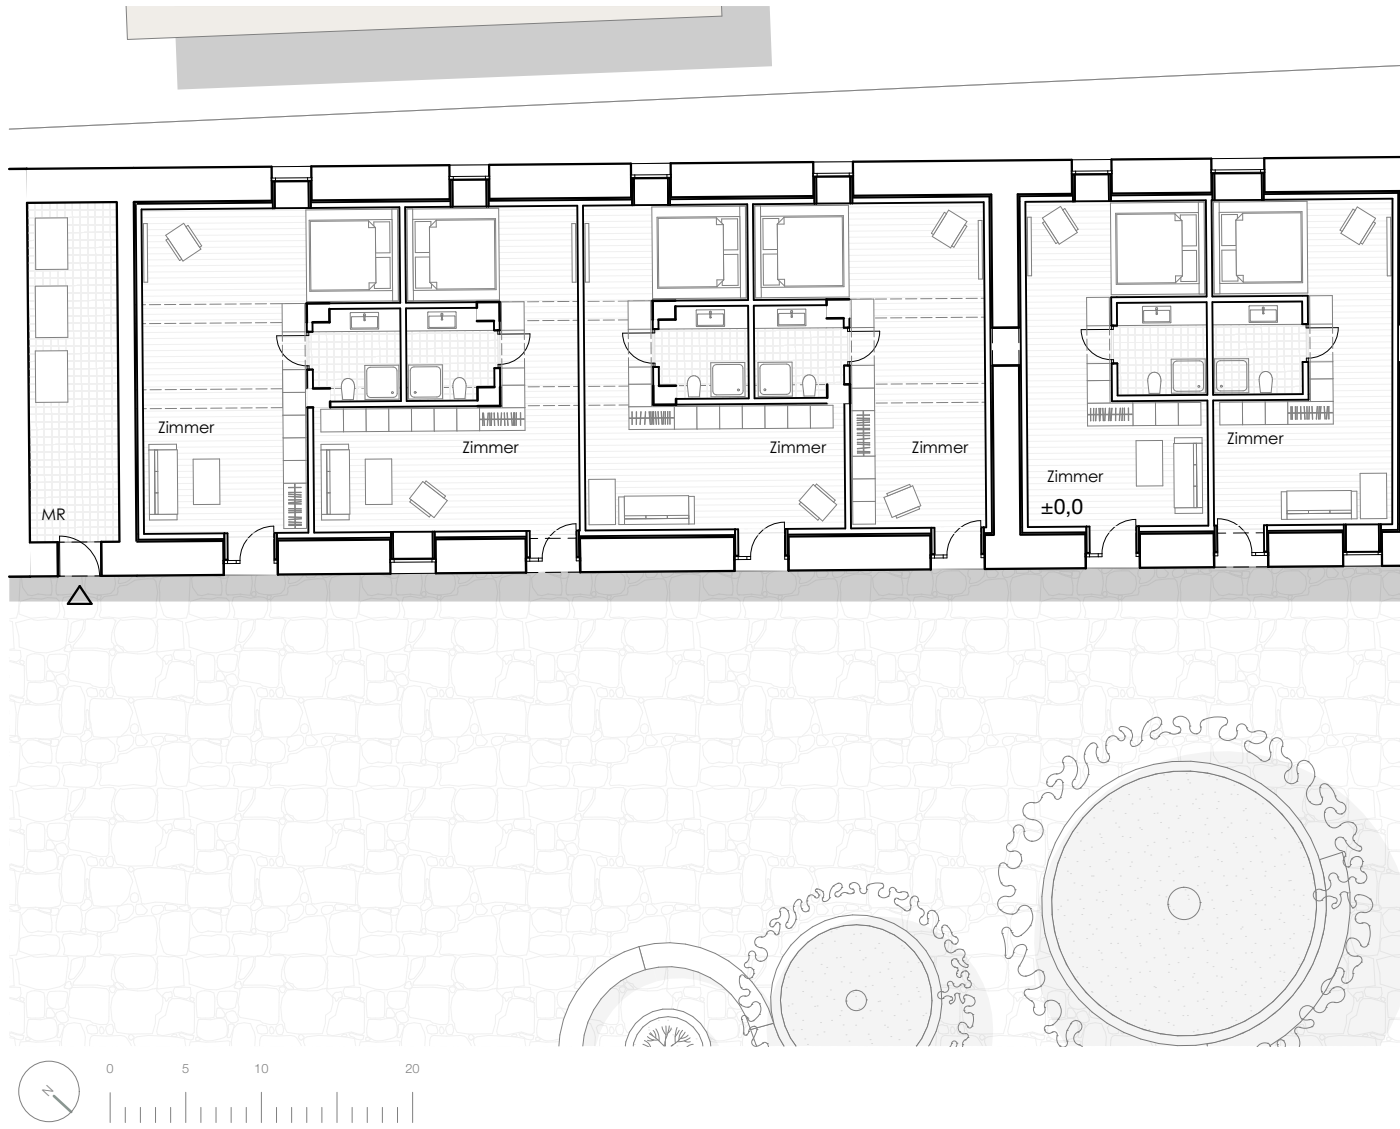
Grundriss Erdgeschoss, Meierhof, M.1:500
